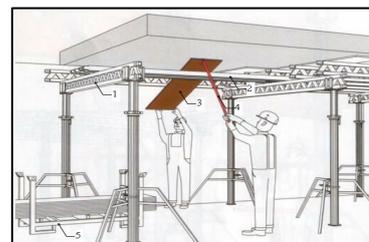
Демонтаж фанеры: 1 – продольная балка; 2 – поперечная балка скантованая «набок», 3 – демонтируемый лист фанеры; 4 – монтажная штанга; 5 – контейнер для складирования фанеры
